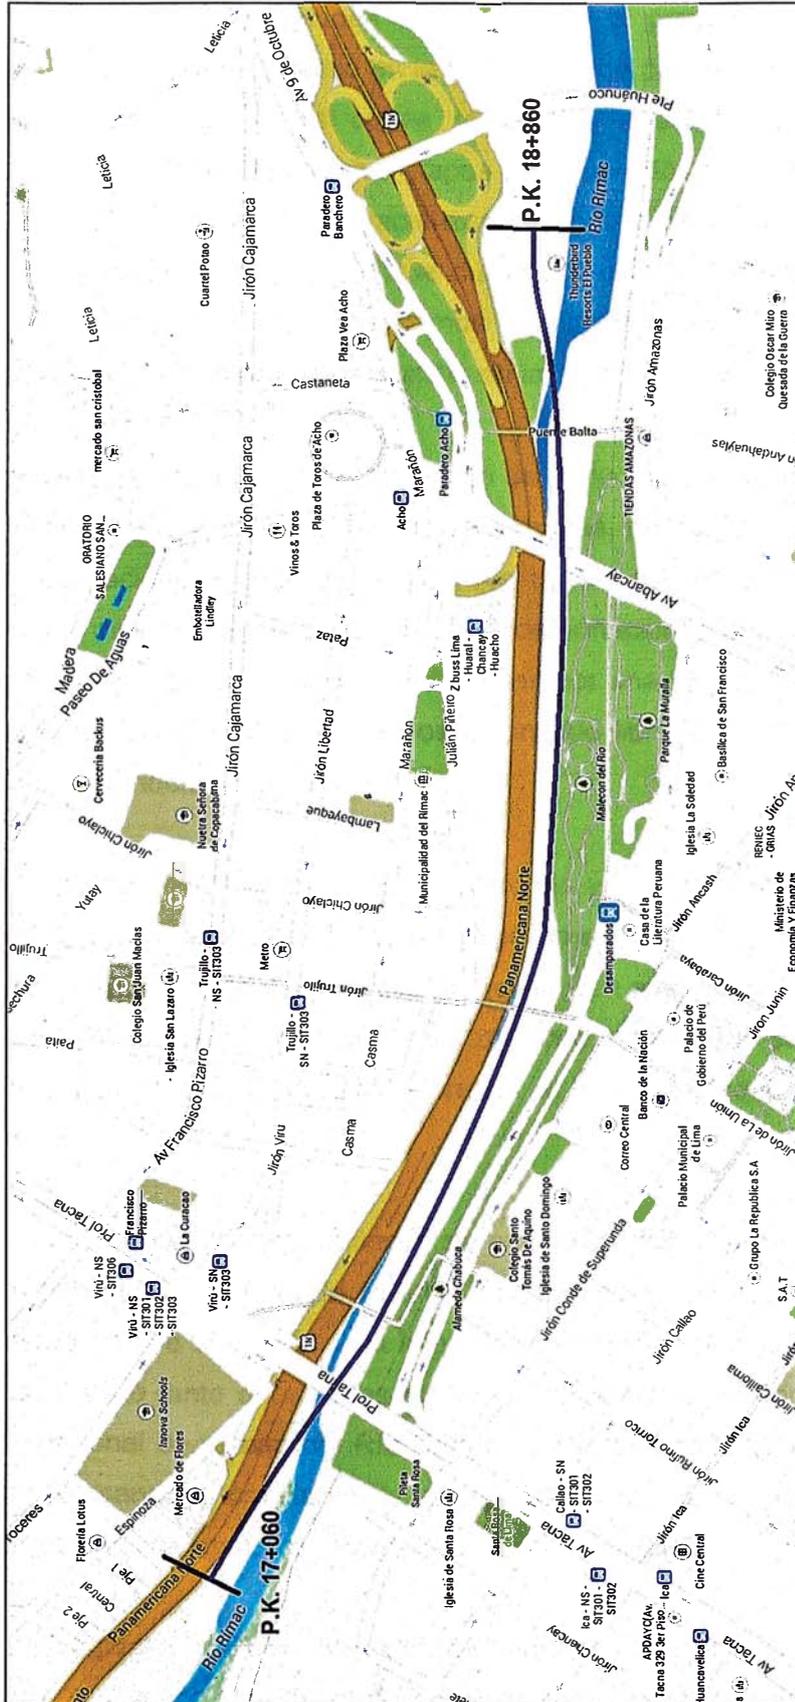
Trazo del túnel de concreto armado (de 17+060 a 18+860).
